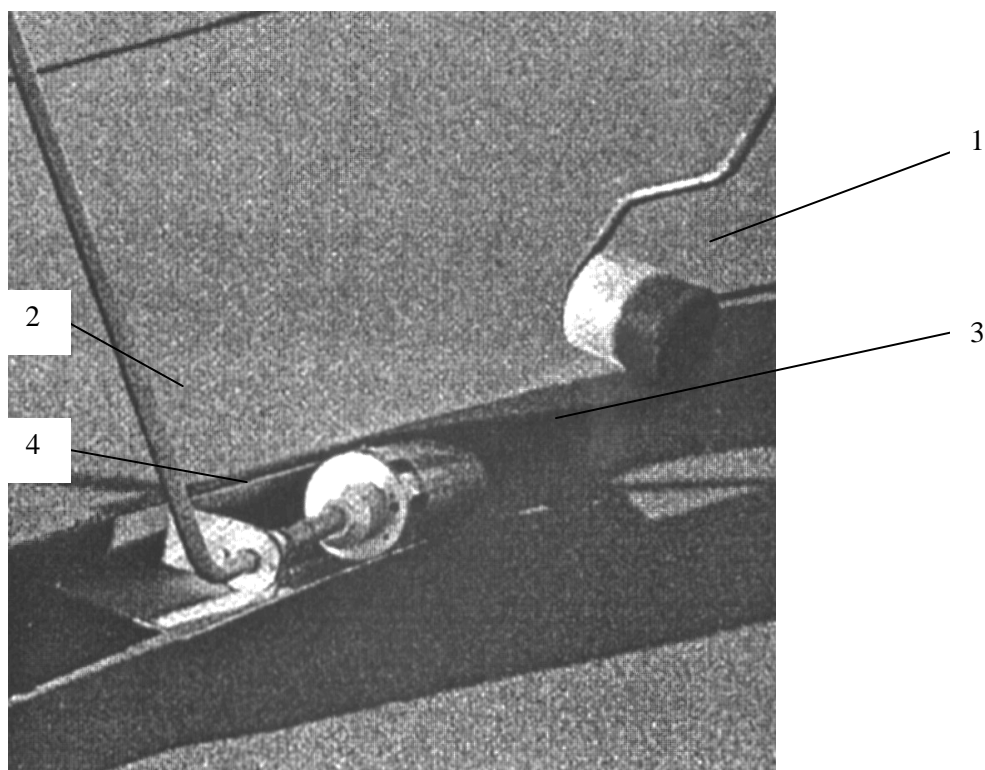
Укладка верхнего рулонного гидроизолирующего слоя и использованием термофена:
